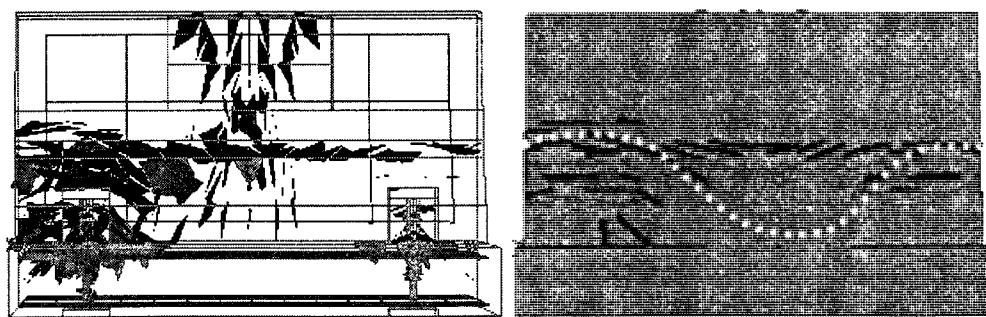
25: Fissuration du parapet en BRP 50MPa-1%
